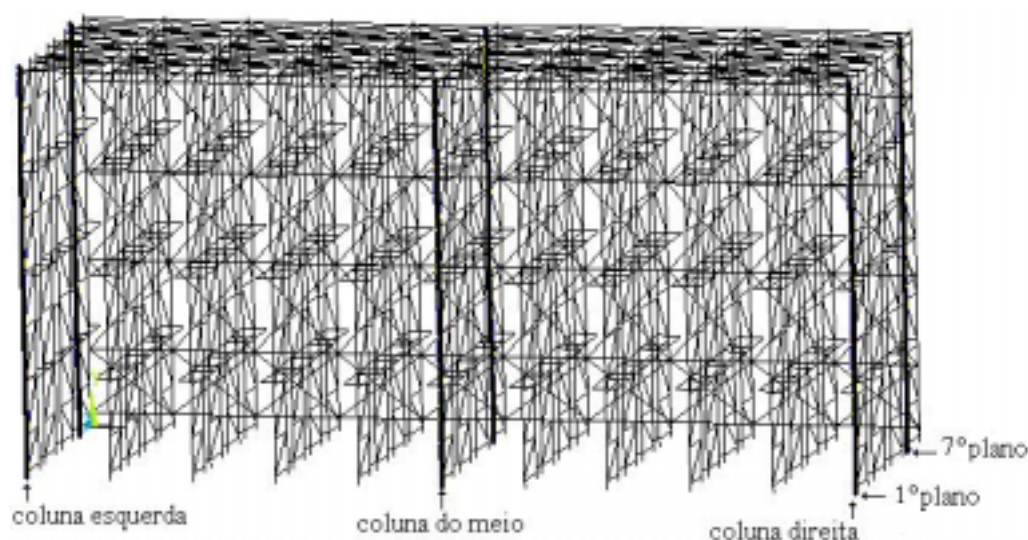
Localização das colunas e dos planos na estrutura tridimensional.
